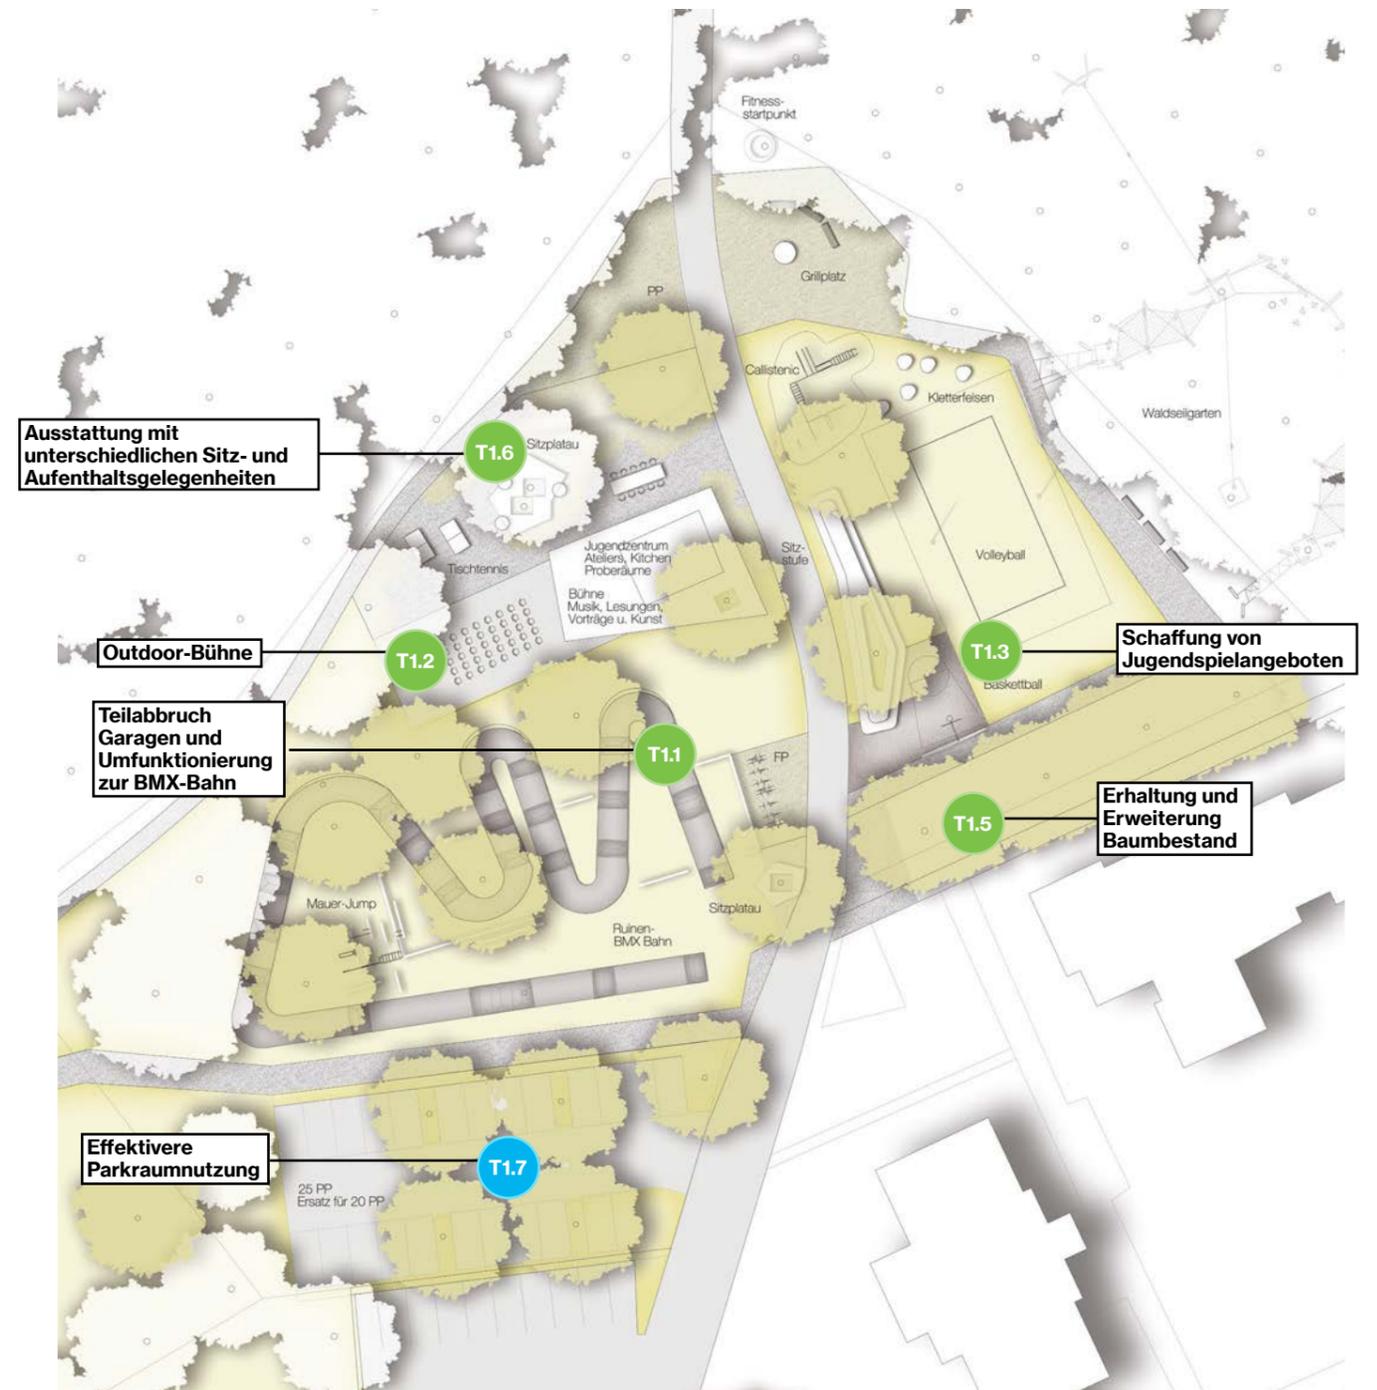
Detailplan Prototyp Sebekstraße, Darstellung: DnD Landschaftsplanung
